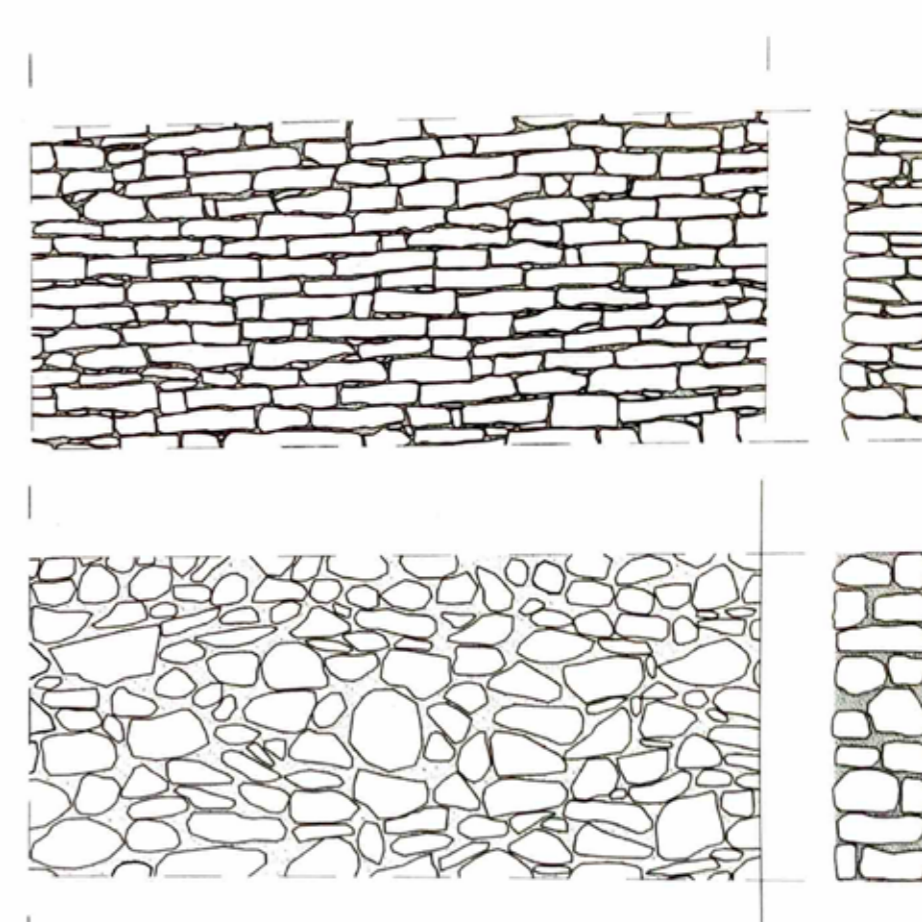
Ejemplos muros de Mampostería (Fuente: Aprendiendo a restaurar)
